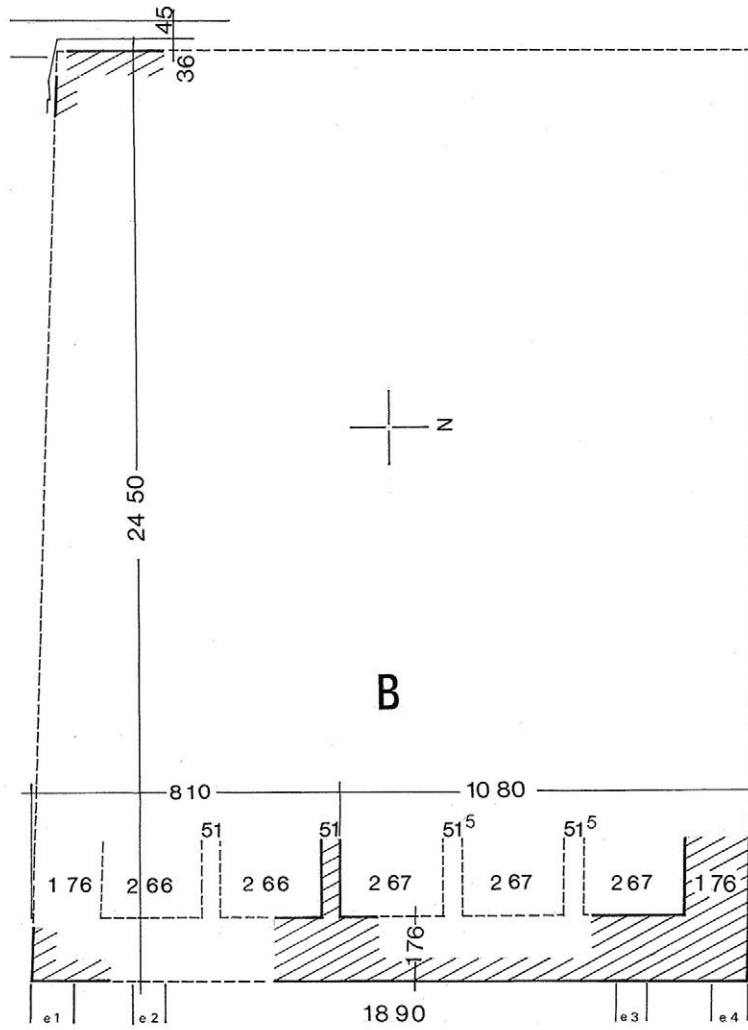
Plan, coté en mètres, des structures connues du temple B (G. Hallier).
